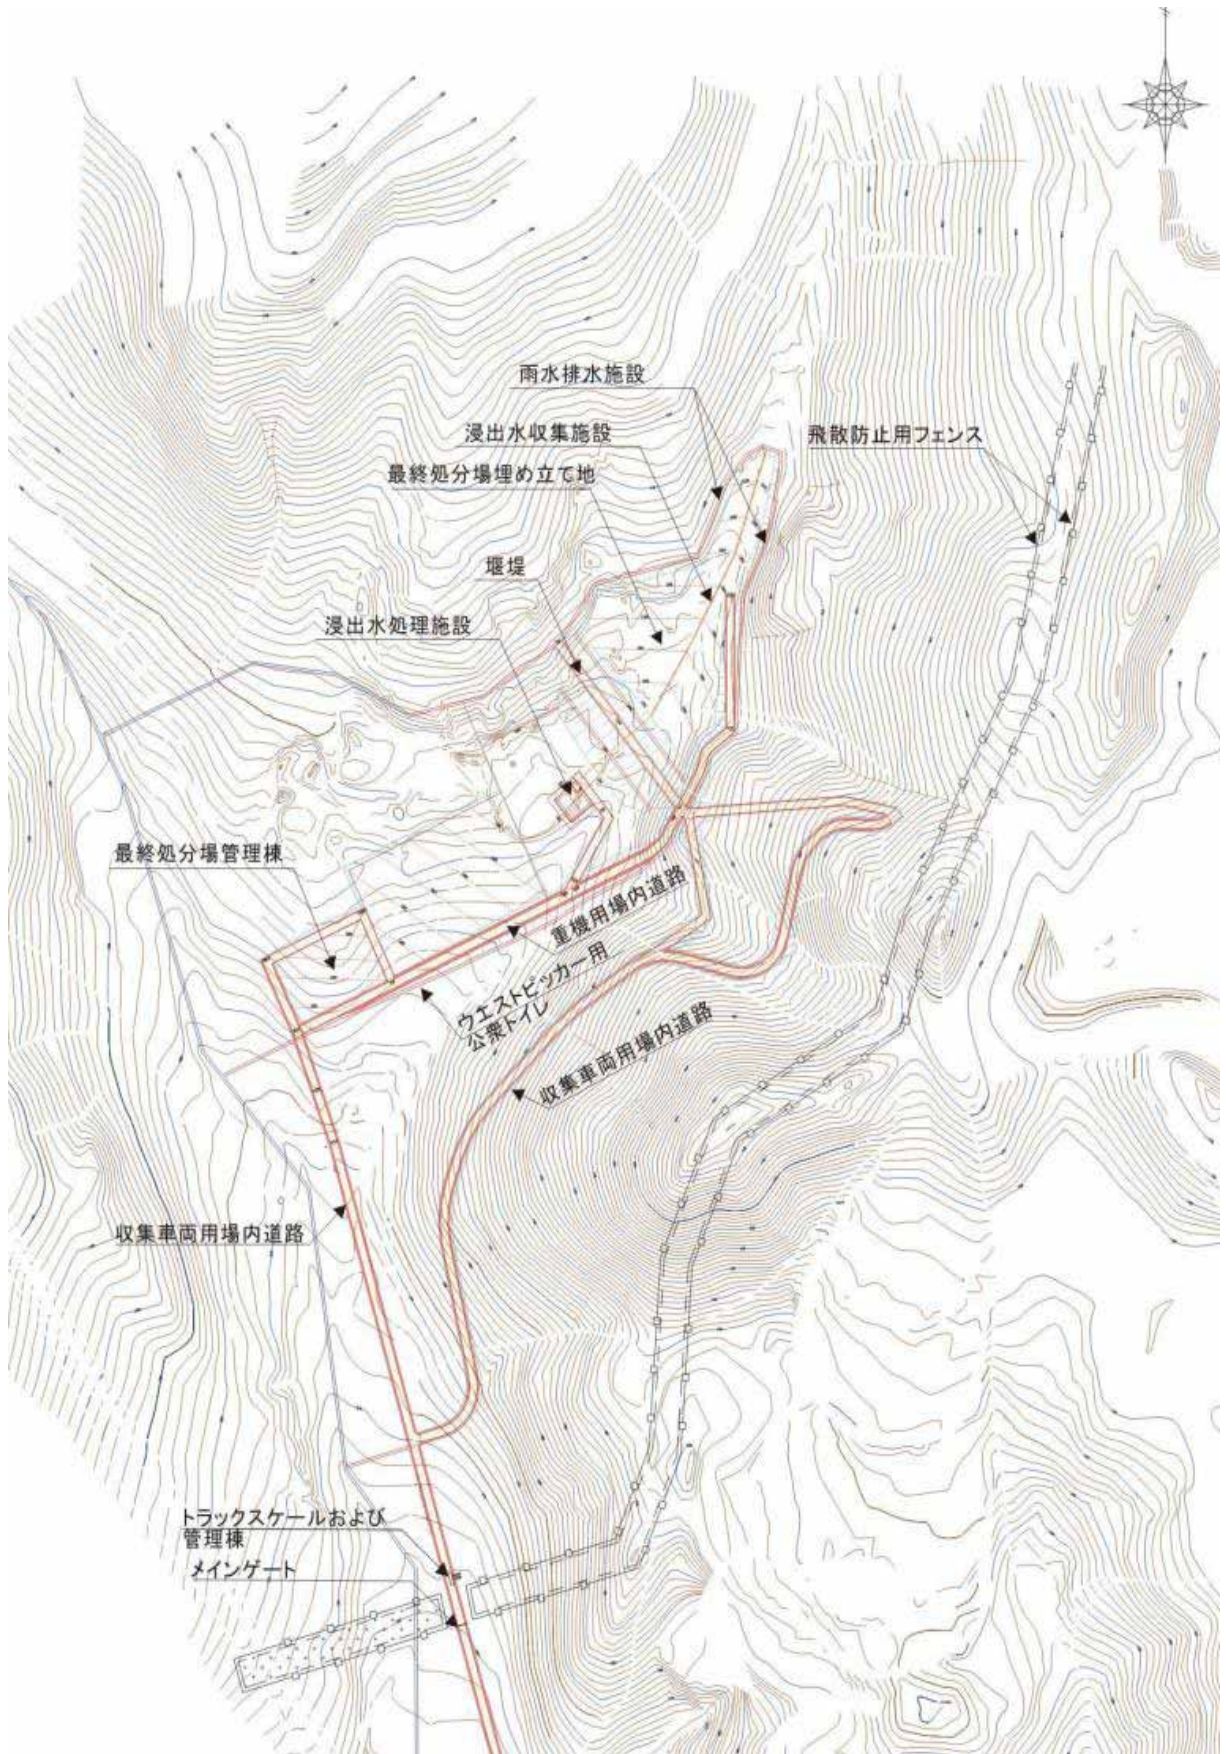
ナランギンエンゲル最終処分場 全体平面図
